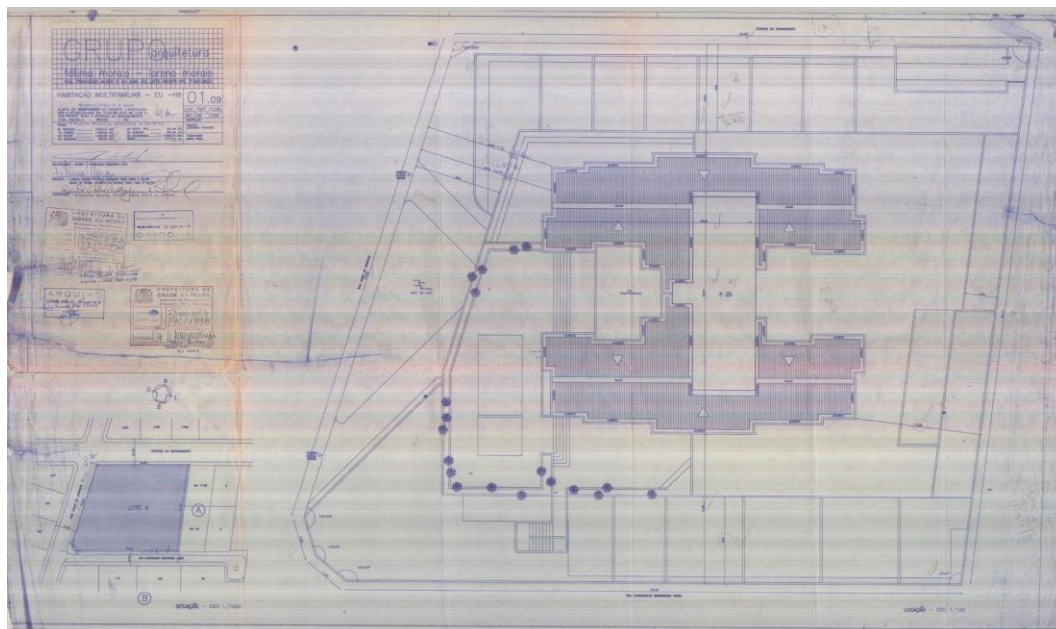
Planta de Locação e Coberta do Edifício Camille Frammarion. Fonte: Arquivo da Prefeitura de Recife (1998).
